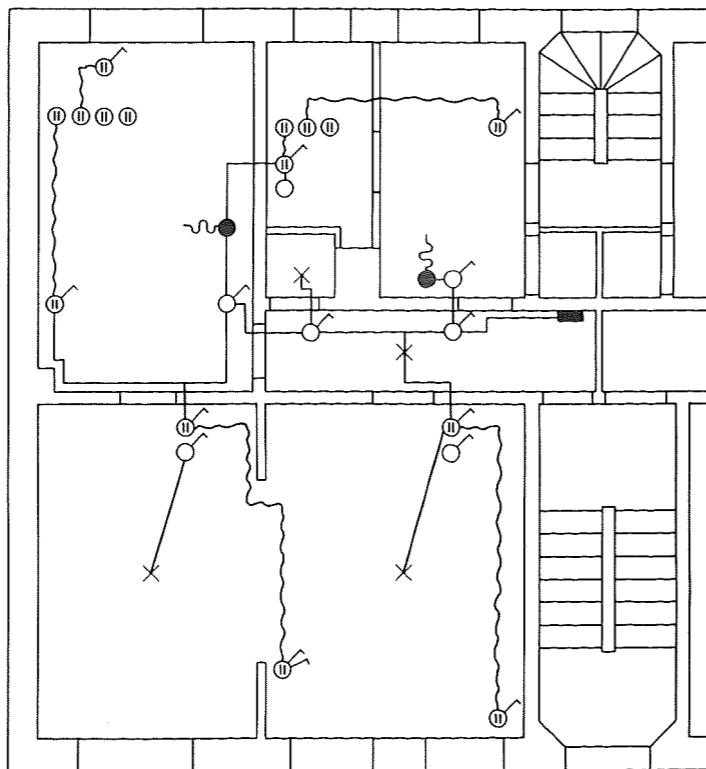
Plan over lejligheden, inden modernisering med den oprindelige faste installation indtegnet.
